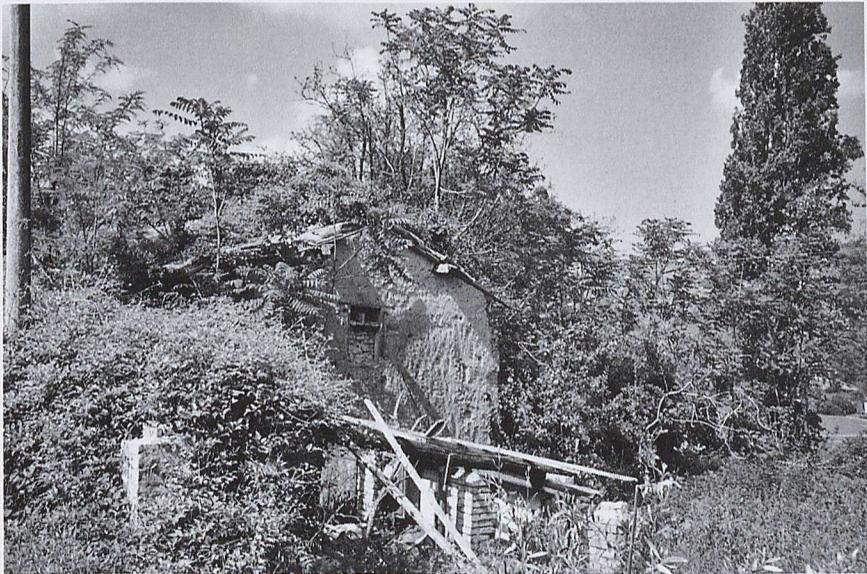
Mondavio, loc. Borghetto, casa di terra.
